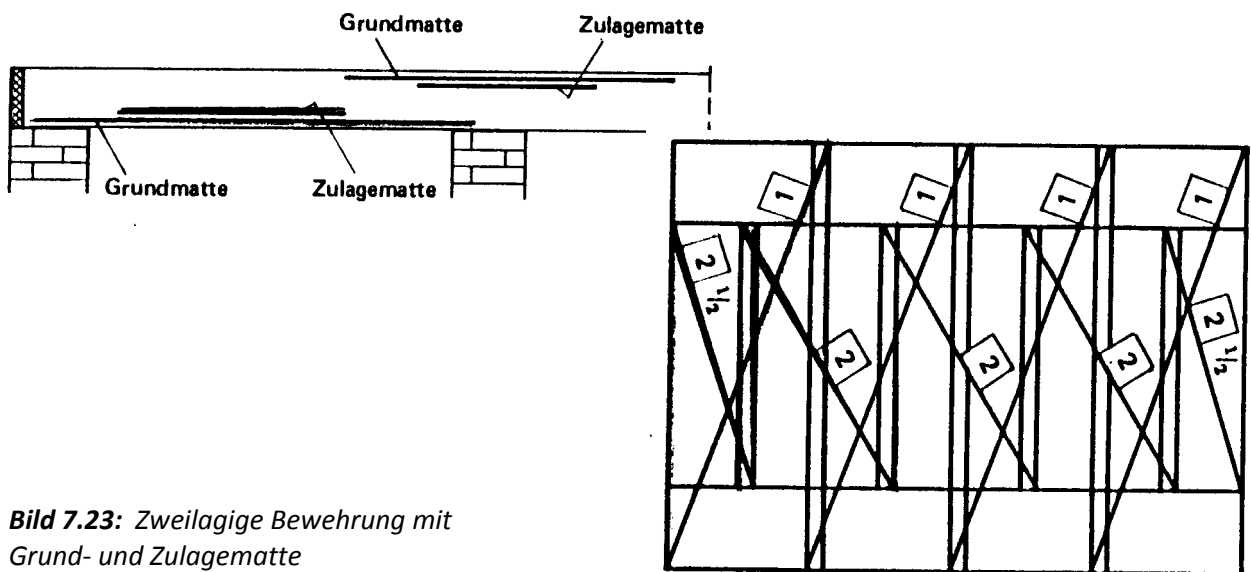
Zweilagige Bewehrung mit Grund- und Zulagematte
